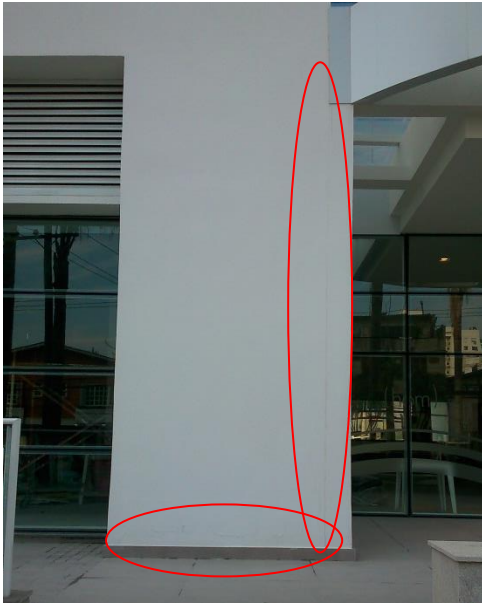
(a) – fissura desenvolvida entre viga e alvenaria e
